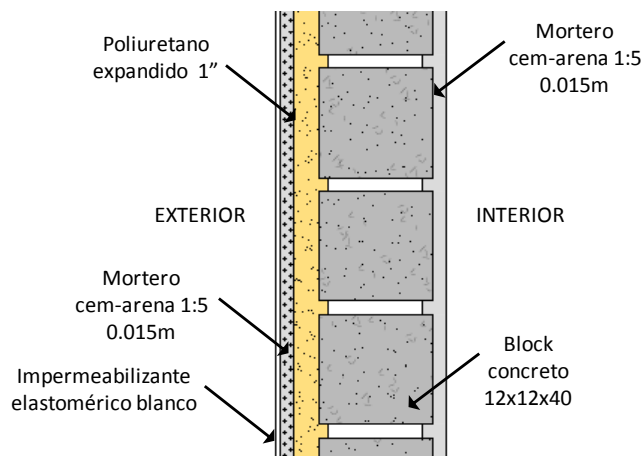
Corte esquemático del aislamiento con poliuretano esparcido de 1" y pintura blanca en muros exteriores de la fachada sur (caso prototipo pre-construcción)
